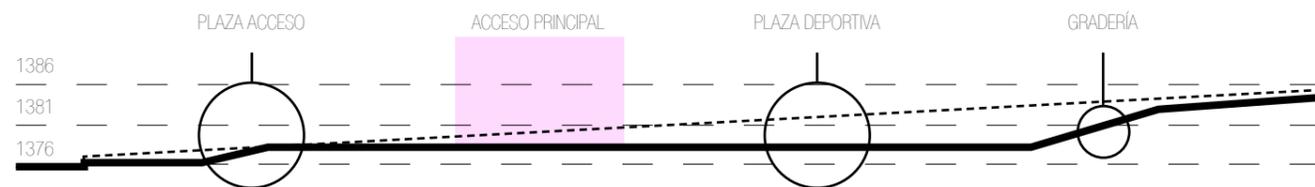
Planta en detalle, Plaza Acceso y Plaza Deportiva.
